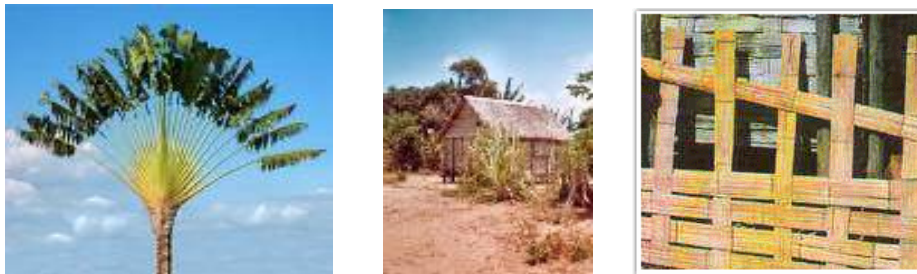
Ravinala, construction traditionnelle à base de Ravinala, construction traditionnelle en bambou aplati (Source www.architecture-madagascar.com)
